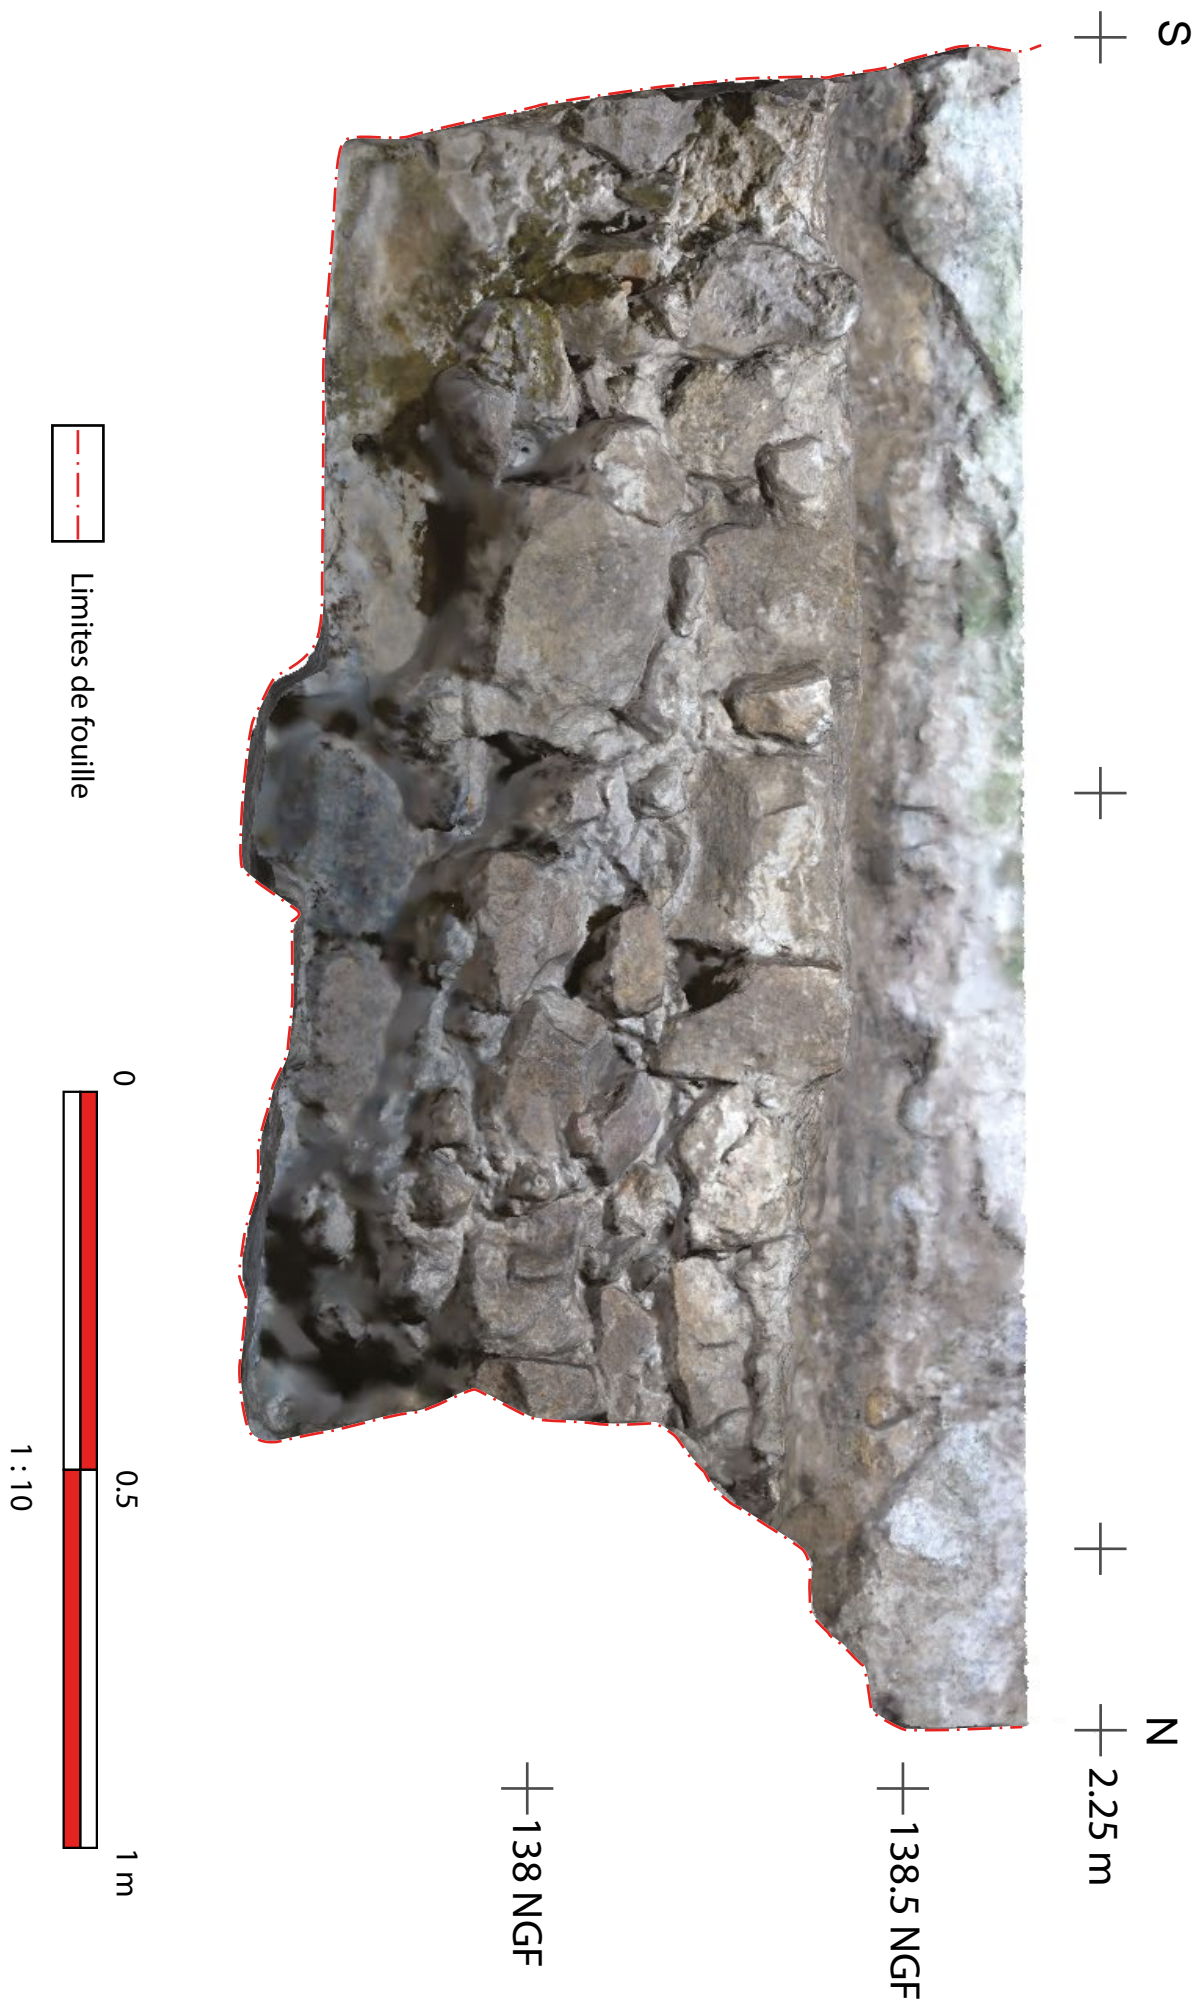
Coupe longitudinale des fondations du mur ouest de la nef de la chapelle, D4 zone 2, 2021 (Photos Lou-Anne Mathieu, D.A.O. Etienne Courné).
